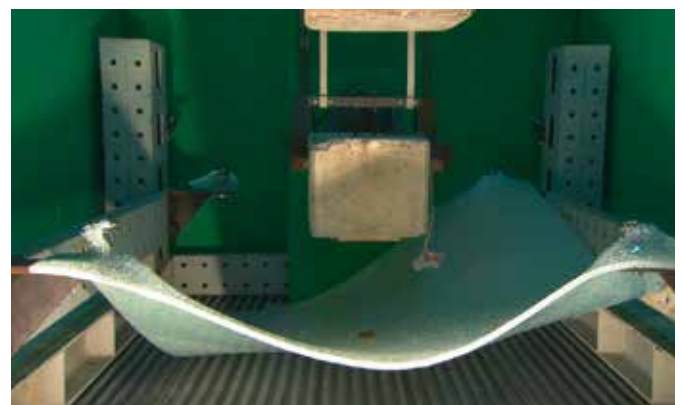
Laminado de PVB rígido colapsou a 50 °C
